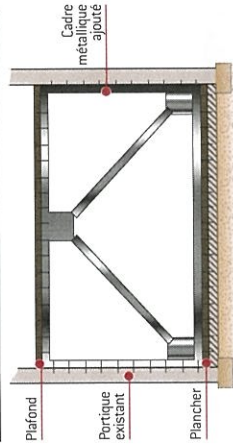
Exemple de renforcement du contreventement par ajout de croix type K ou Saint-André en charpente métallique ou en poutre de béton armé à un portique existant (coupe transversale)
